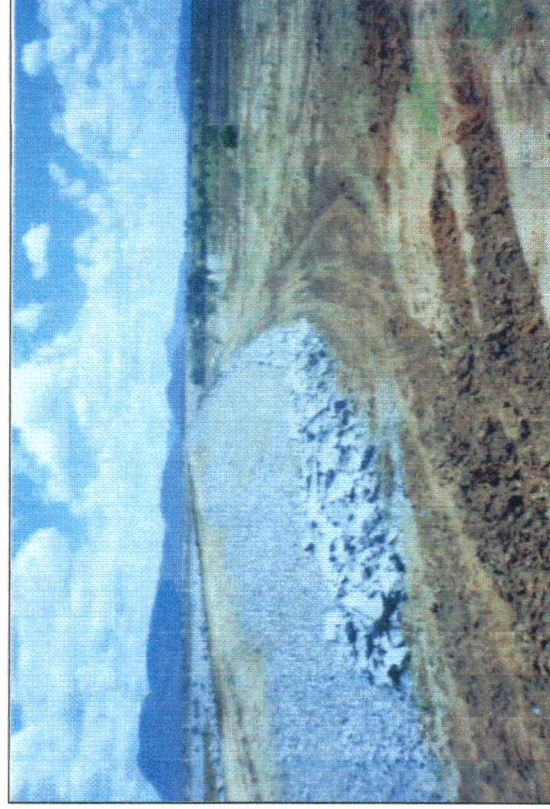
Vista de jusante da barragem, mostrando o rock-fill após arrumação final.
